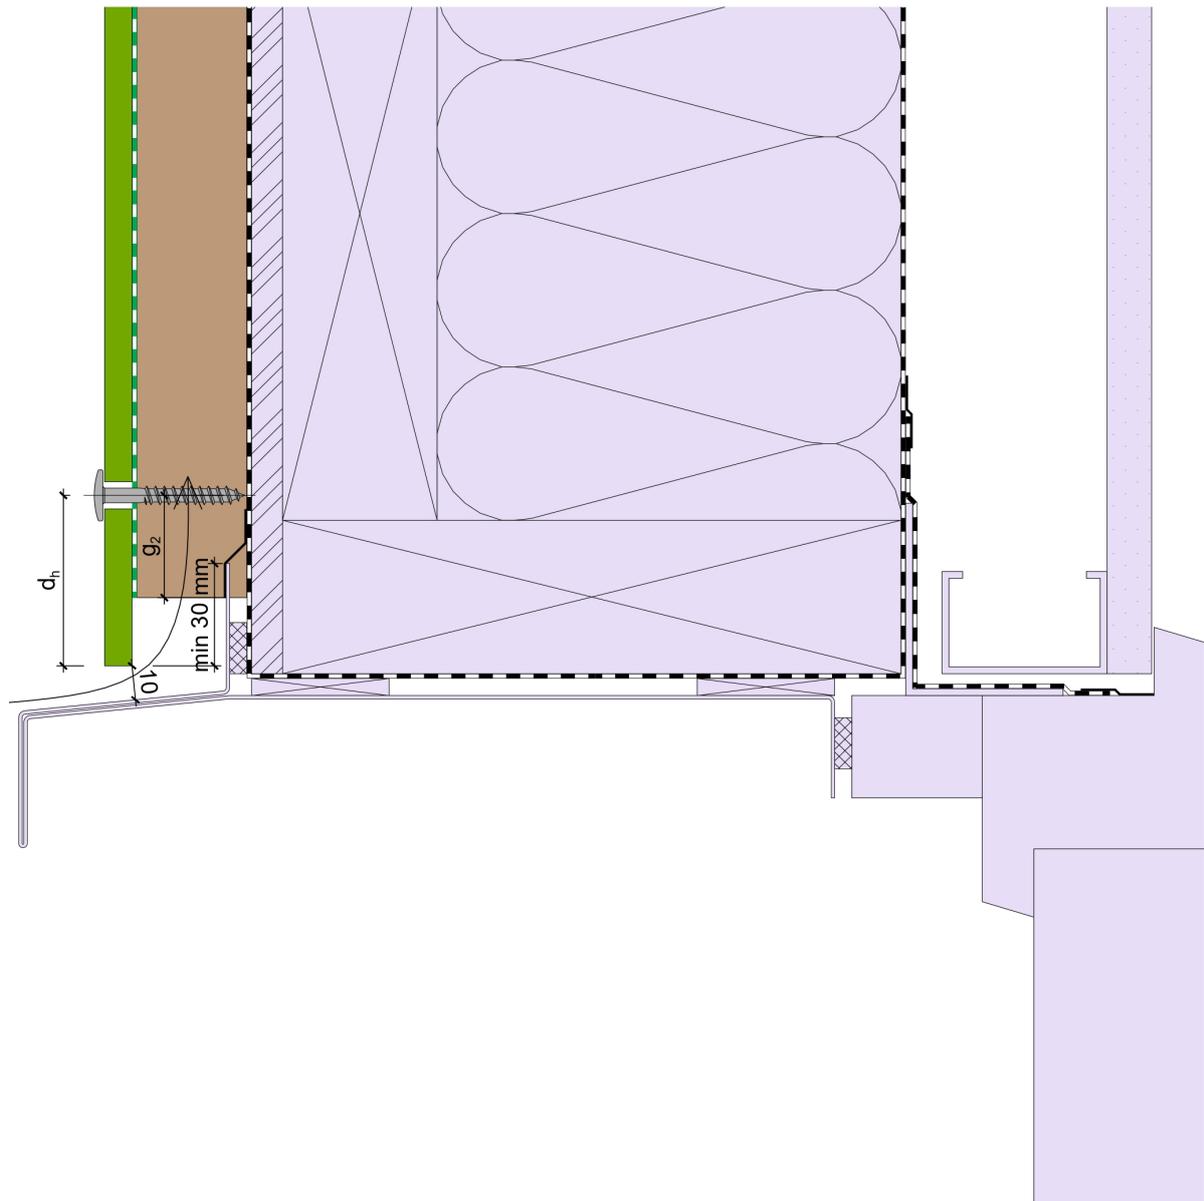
Détail sur linteau menuiserie extérieure compatible avec le niveau d'exigence Ee2 (coupe verticale)
